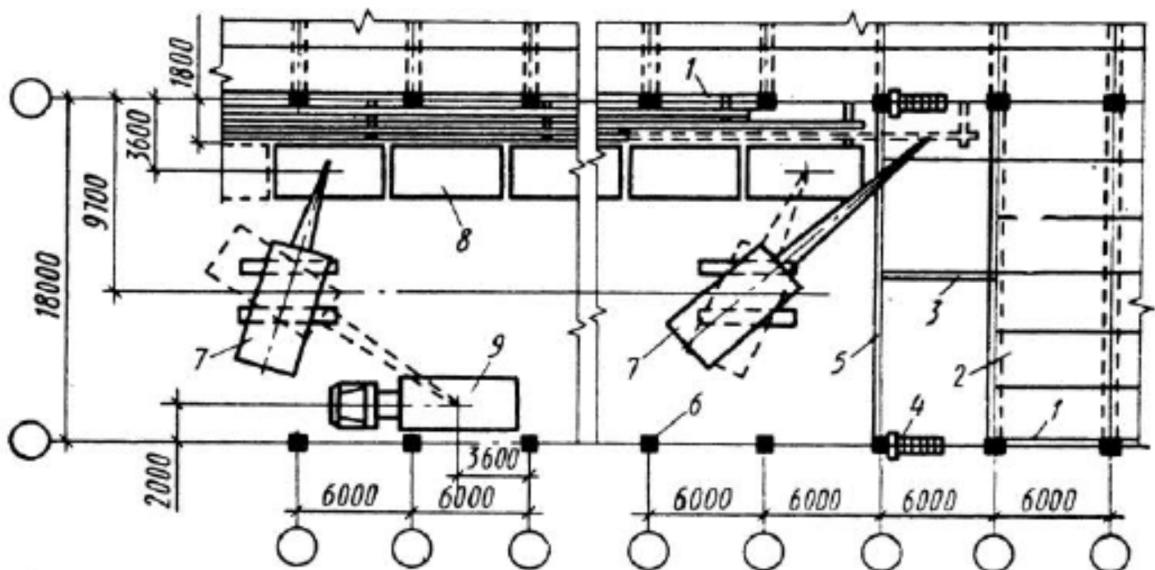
Схема выгрузки, раскладки элементов и монтажа покрытия пролетом 18 м с шагом колонн и ферм 6 м продольным методом: 1 - временное ограждение; 2 - смонтированное покрытие; 3 - инвентарная распорка для временного крепления ферм; 4 - лестница-площадка приставная; 5 - стропильная ферма; 6 - колонна; 7 - кран; 8 - штабель плит; 9 - транспортное средство.
